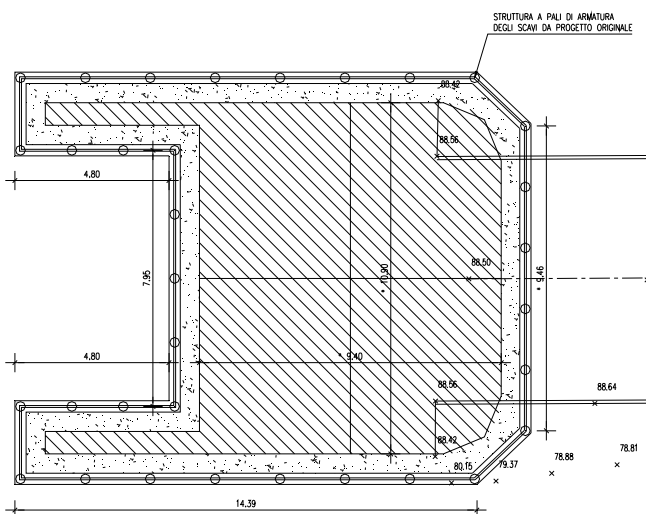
Sezione spalla allo spicco fondazione
